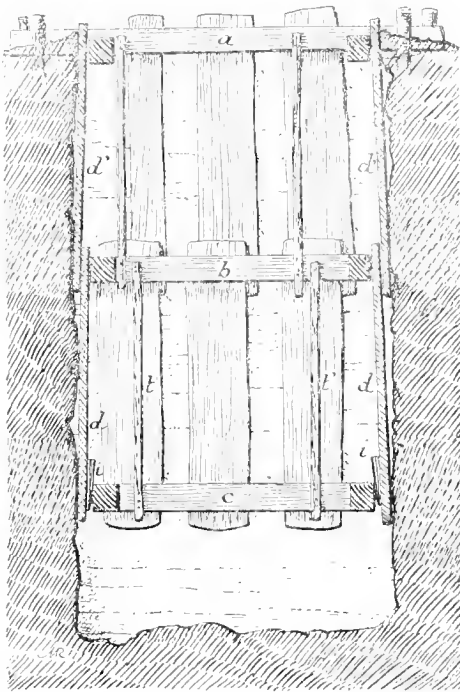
Coupe verticale du coffrage d'une fouille de puits rectangulaire.
